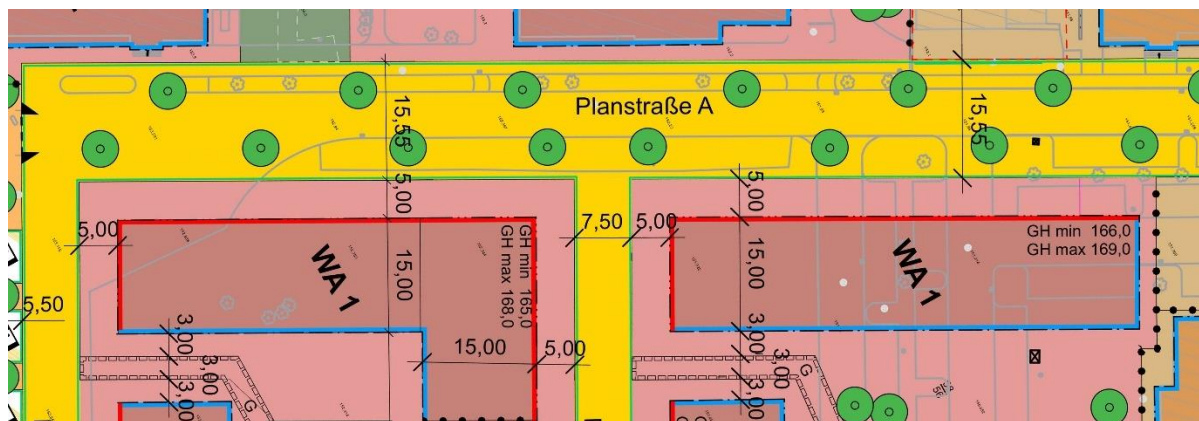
Vorentwurf Bebauungsplan Nr. II/6 „Jägerkaserne I / Ludwig-Mond-Straße“ (Ausschnitt) – Stand Mai 2024
